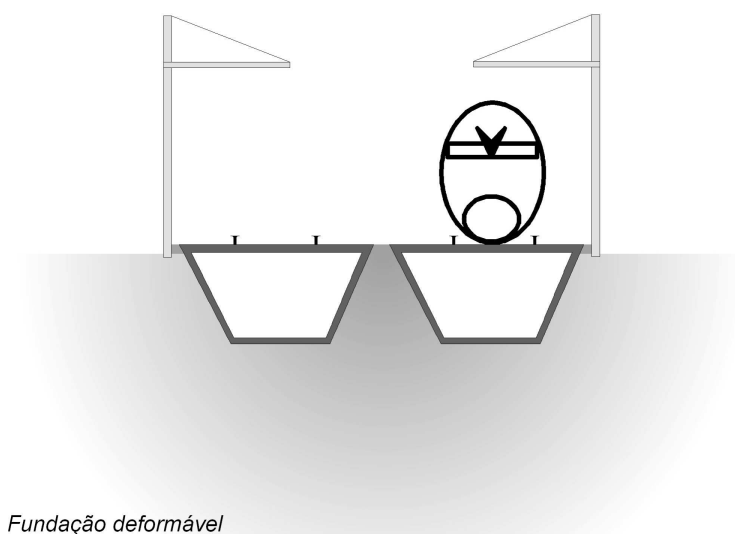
Via em caixão vazado continuamente apoiado na fundação
